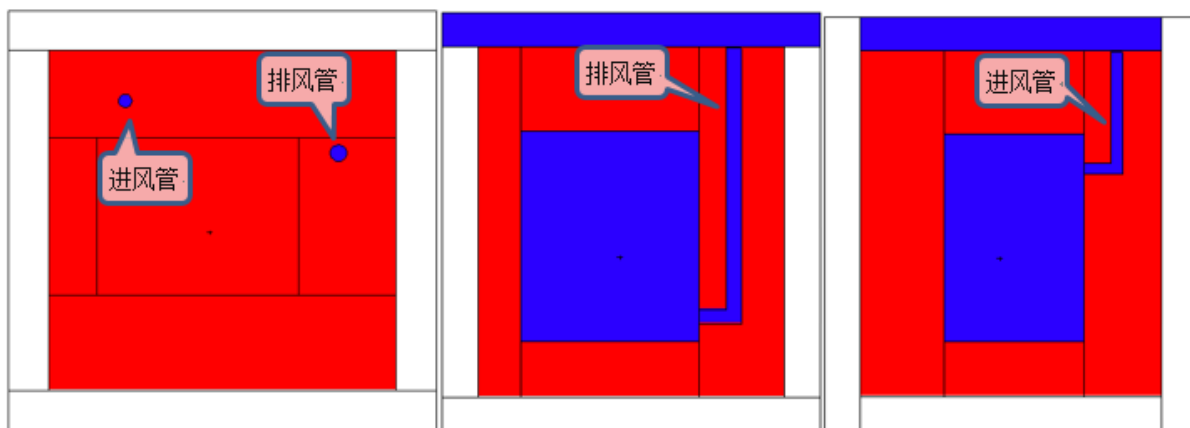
进、排风口计算示意图（平面图、排风管立面图、进风管立面图）
